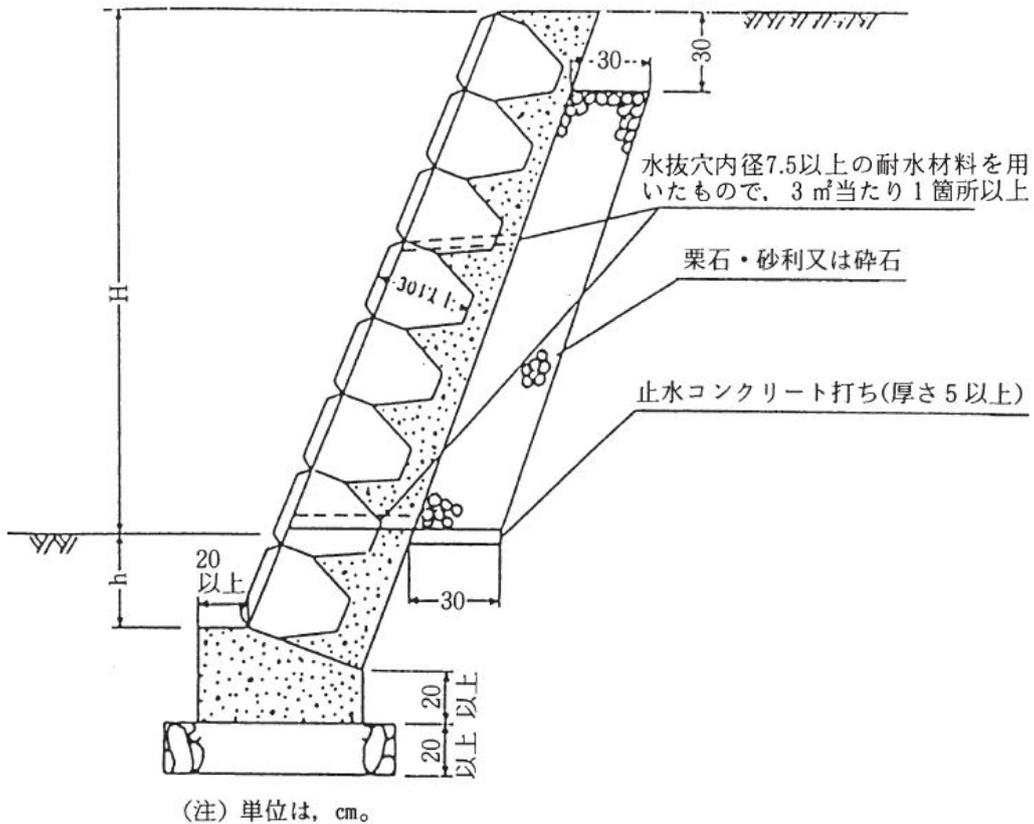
練積み造擁壁の標準断面図 (切土の場合)
